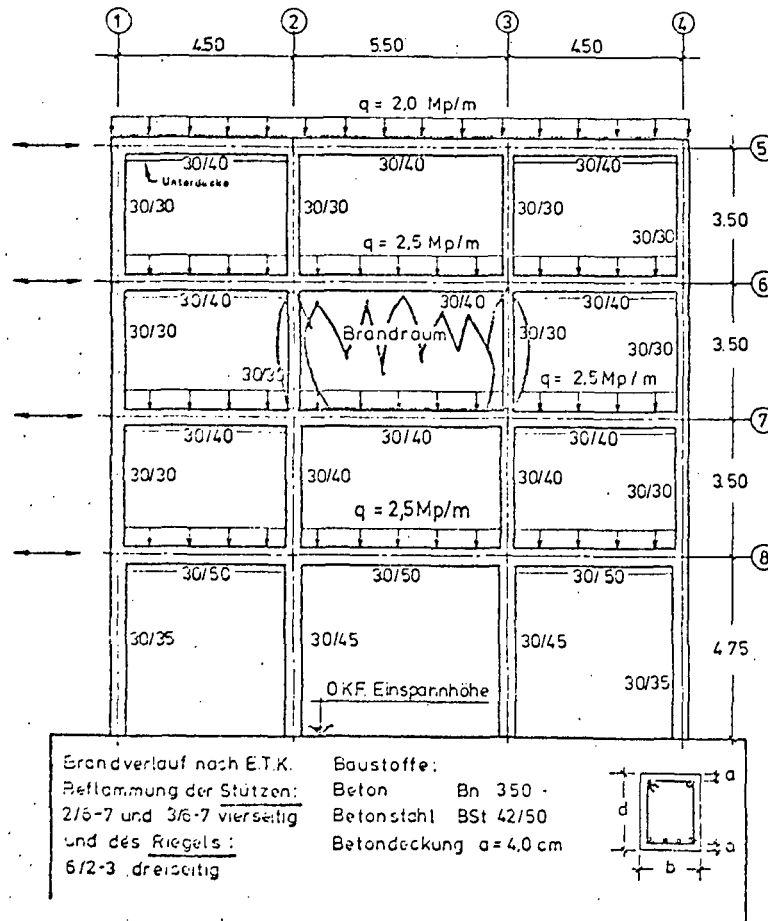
Geometrie des untersuchten mehrgeschossigen verschieblichen Stahlbeton-Rahmens
